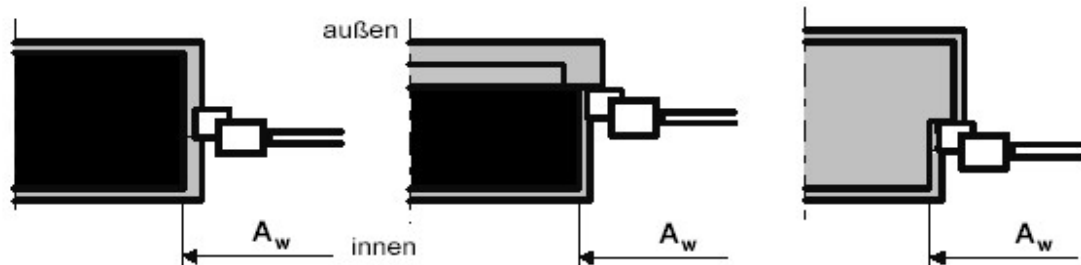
Ermittlung des lichten Rohbaumaßes bei Fensteröffnungen (stumpfer Anschlag, zweischaliges Mauerwerk, mit Innenanschlag)  $A_w$  = Fensterfläche (Index w - window, Fenster)
